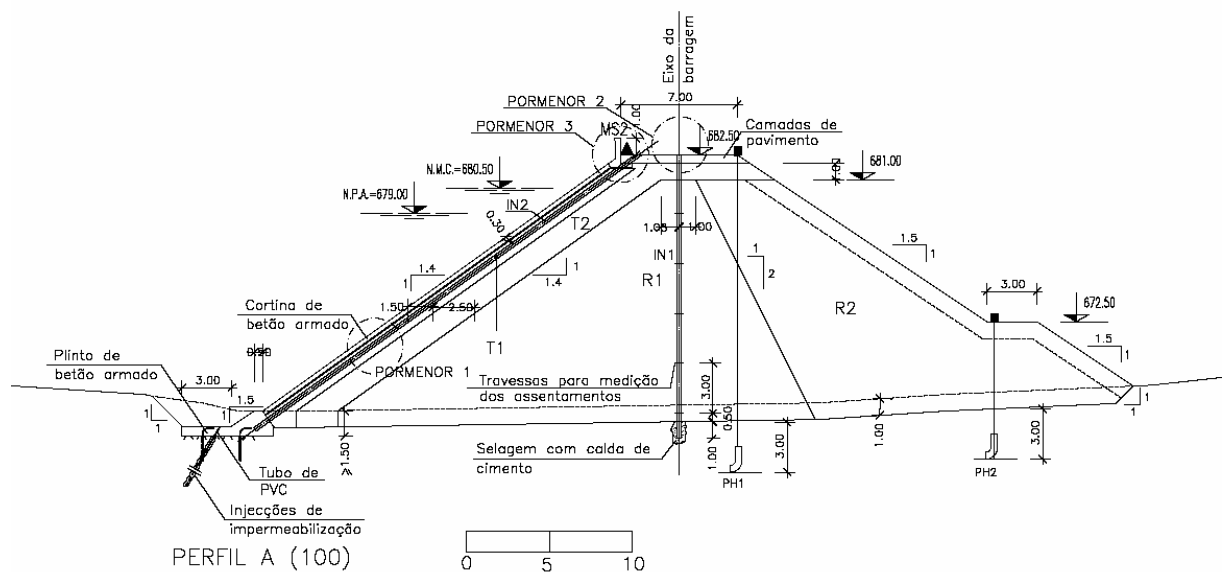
Exemplo de perfil transversal com os dispositivos de observação (marcas superficiais, piezómetros na fundação e inclinómetros)
